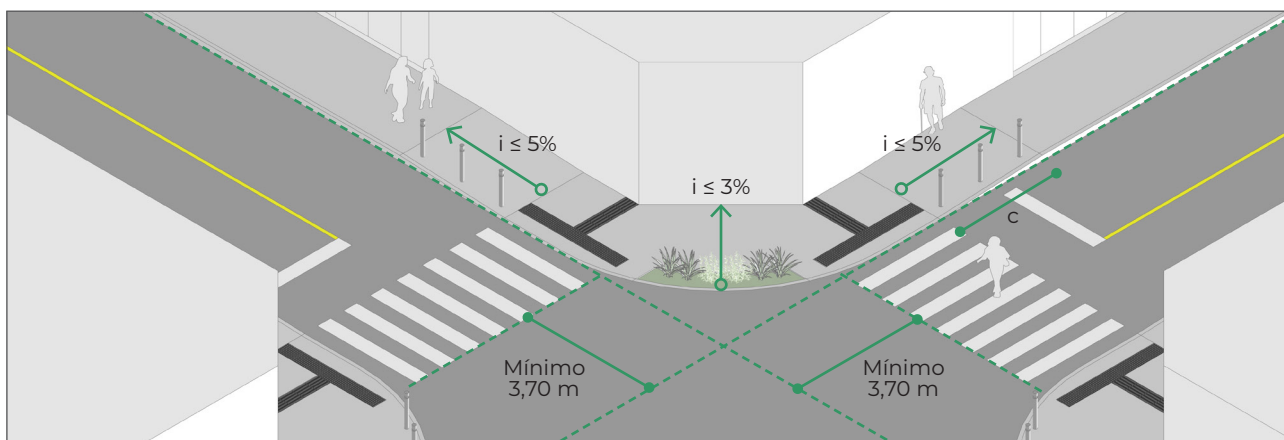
Travessia em calçada estreita com esquina rebaixada e canteiro utilizado como dispositivo para bloqueio de veículos, a fim de garantir a segurança dos pedestres no trecho rebaixado.
